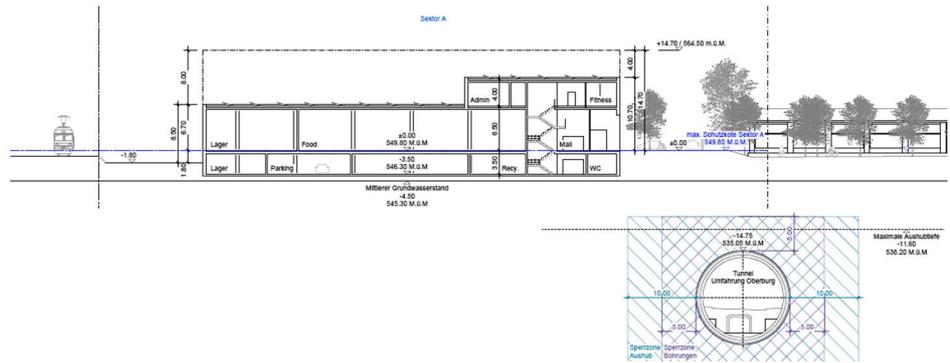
Lage der Tunnelröhre in Bezug auf den Neubau (Querschnitt senkrecht zu den Bahngeleisen)
